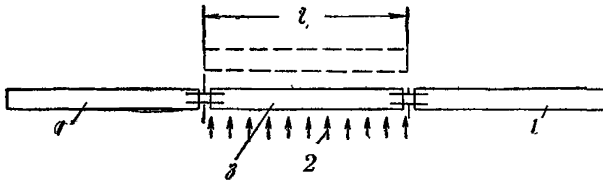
Расчетная схема для шарнирно соединенных плит
